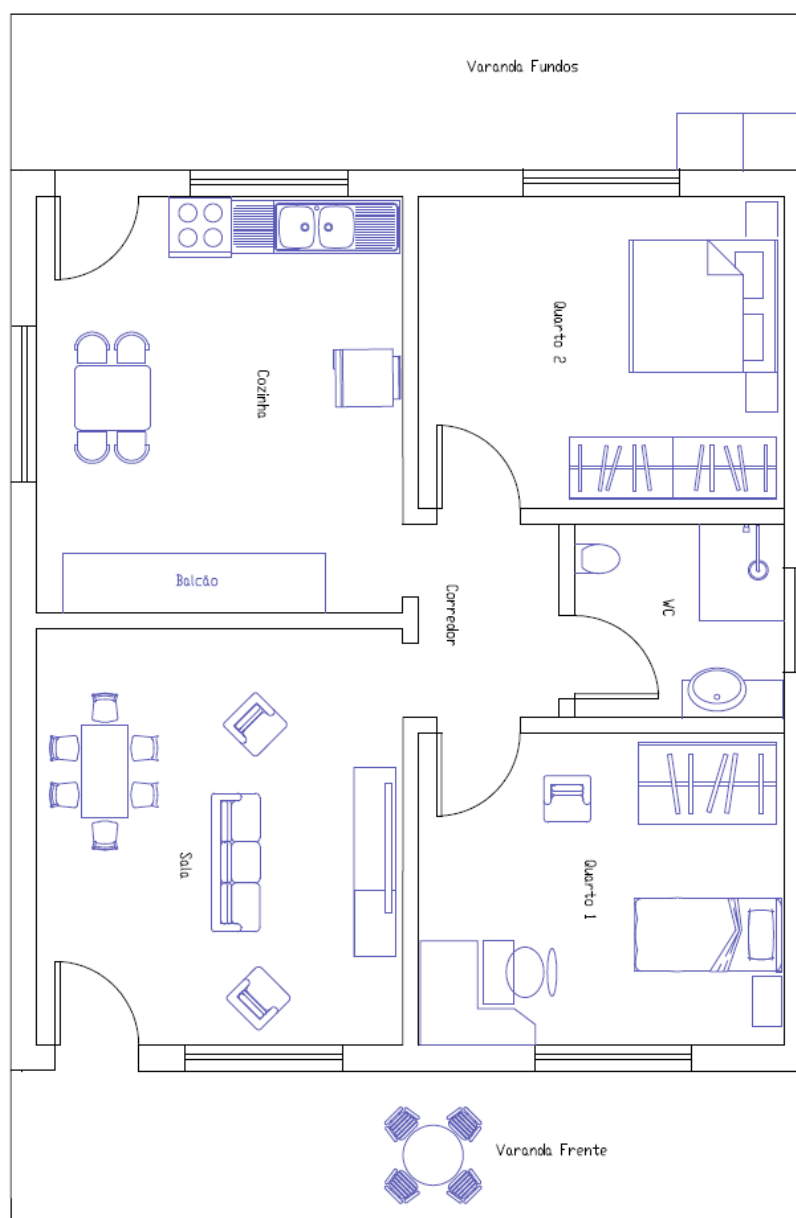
PLANTA BAIXA RESIDENCIAL
